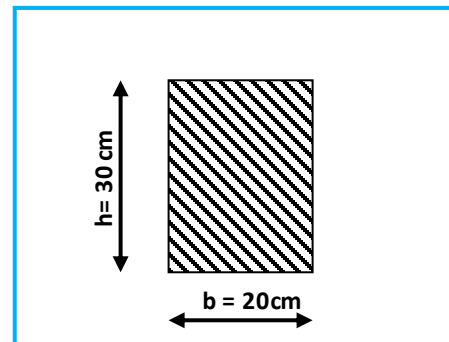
Les dimensions de la poutre de chaînage.
